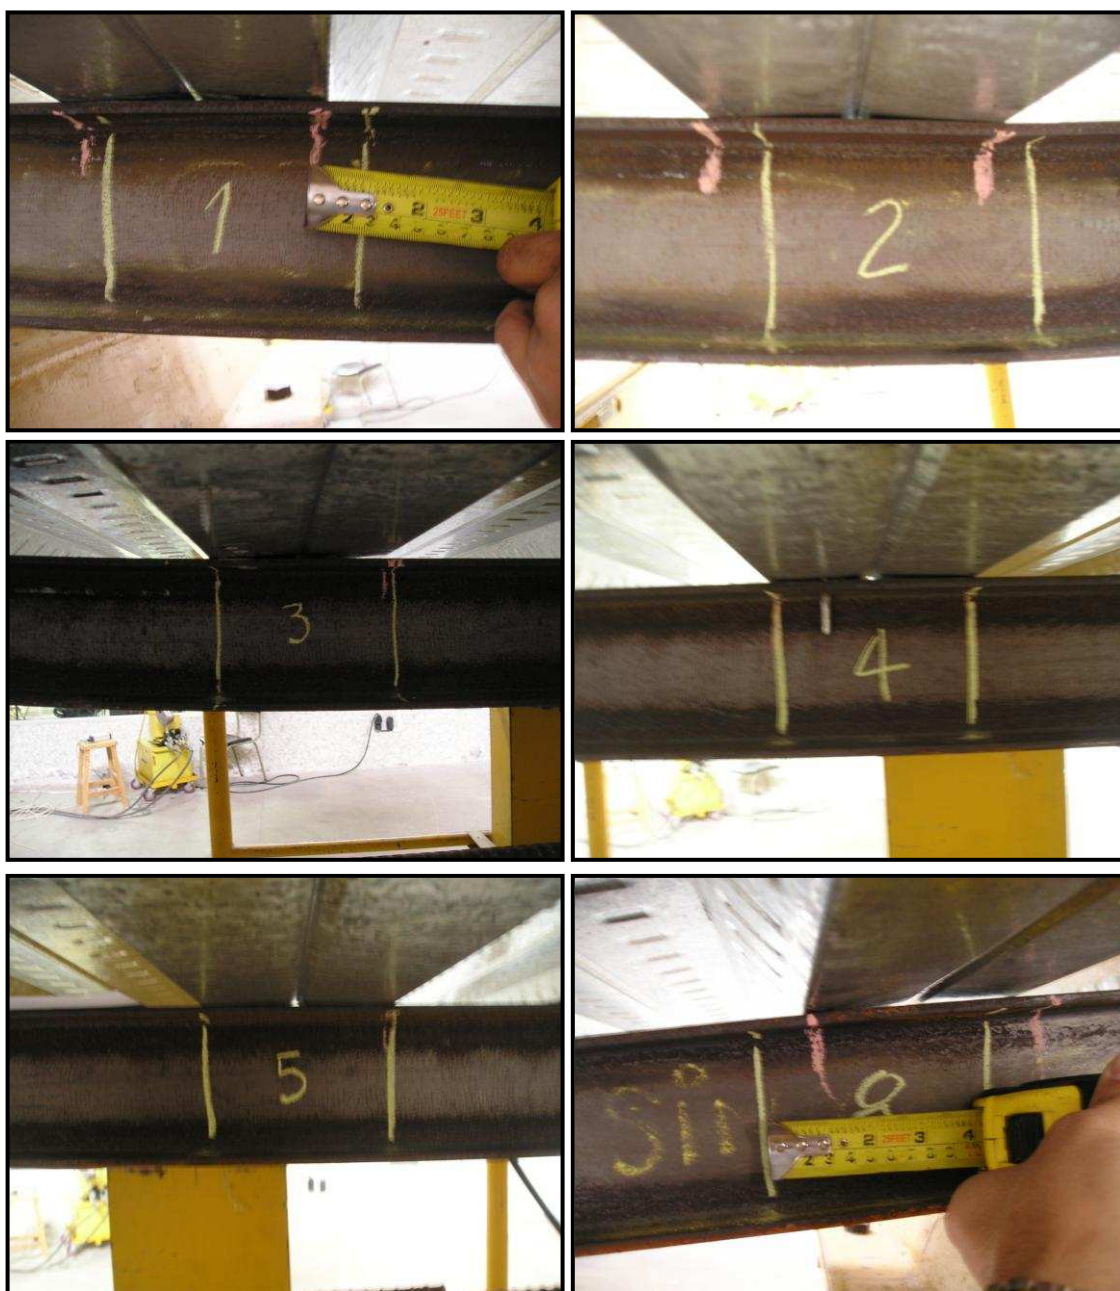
DESPLAZAMIENTO HORIZONTAL DE LOS DISTINTOS VALLES
